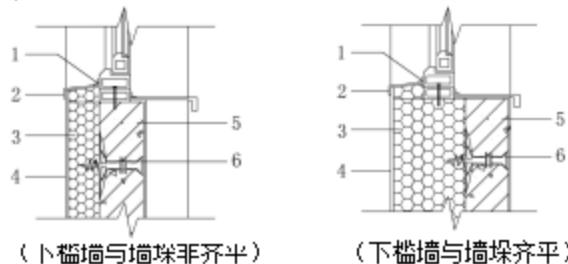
窗下槛墙与墙垛连接组合构造示意
